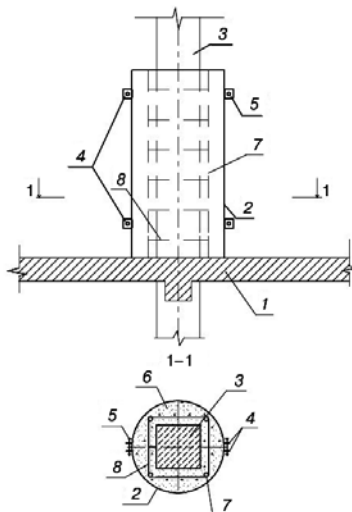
Усиление с помощью комбинированного армирования: 1 – плита перекрытия; 2 – U-образный металлический лоток; 3 – усиливаемая колонна; 4 – фланцы; 5 – болты; 6 – фибробетон; 7 – продольная арматура; 8 – поперечная арматура
